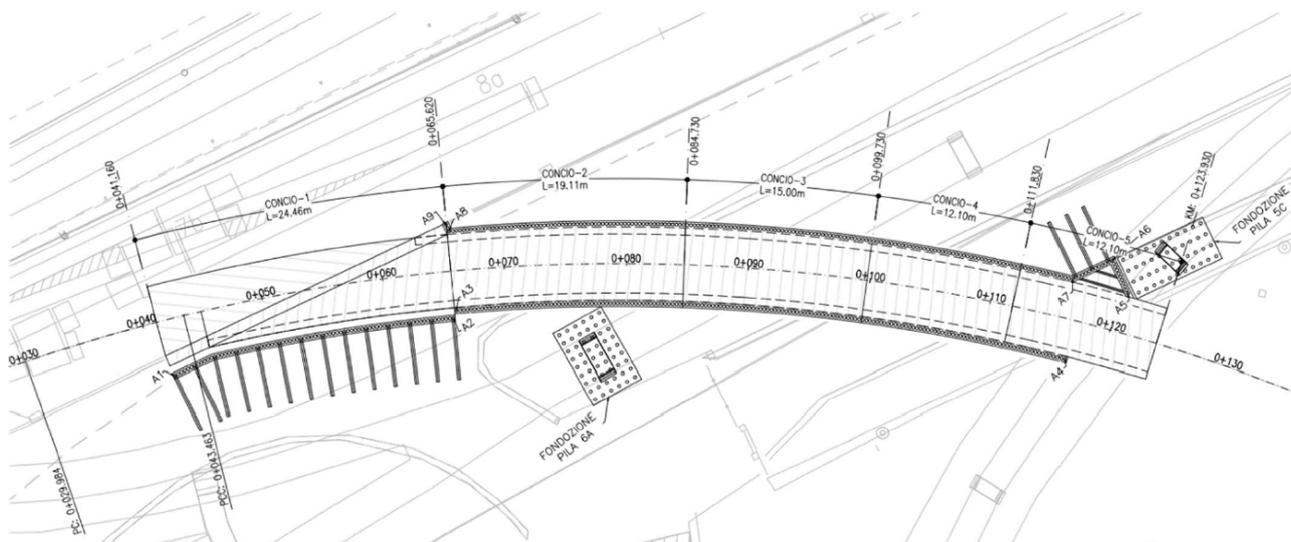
Planimetria del progetto della galleria su cartografia. Fonte: Relazione generale, allegato alla Lista di controllo
